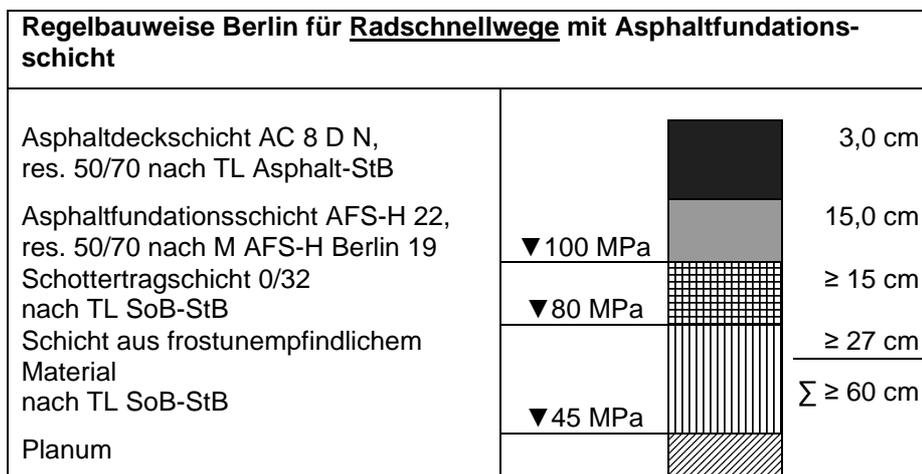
Bauweise für Radschnellwege mit Asphaltfundationsschicht
